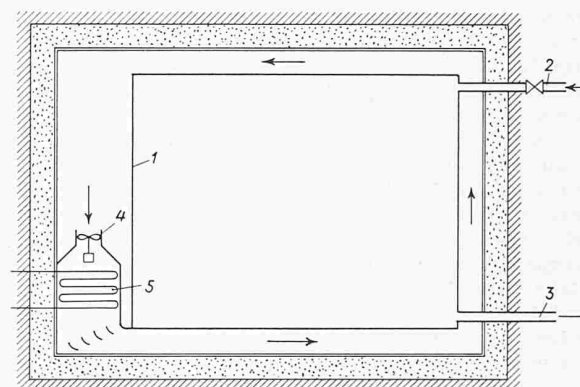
Gaslagerraum mit eingebautem Luftkühler
